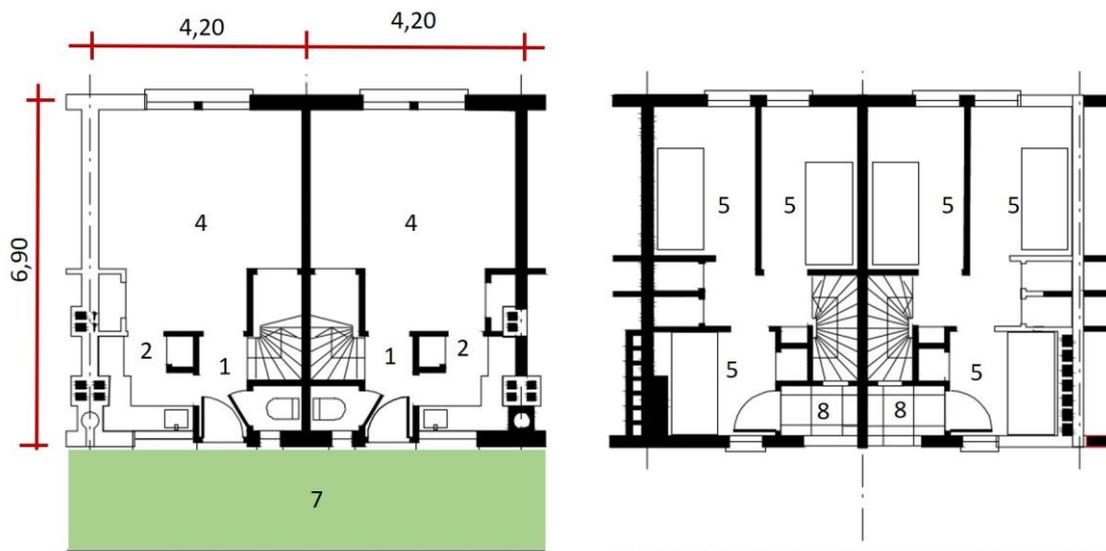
Planta baixa do 3º pavimento (duplex)/ Planta baixa do 4º pavimento (andar superior duplex).
